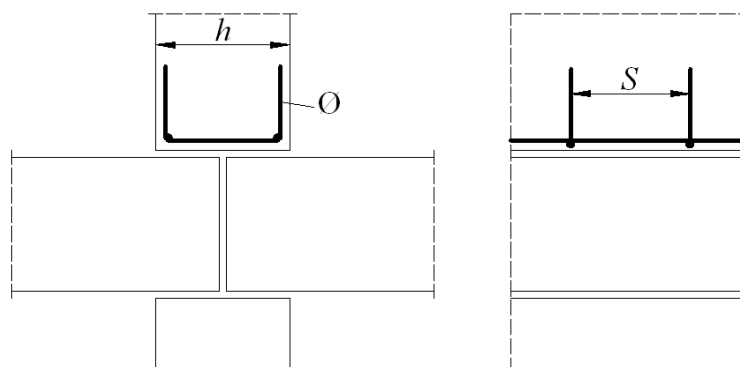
Пример армирования стены над стыком двух плит перекрытия
